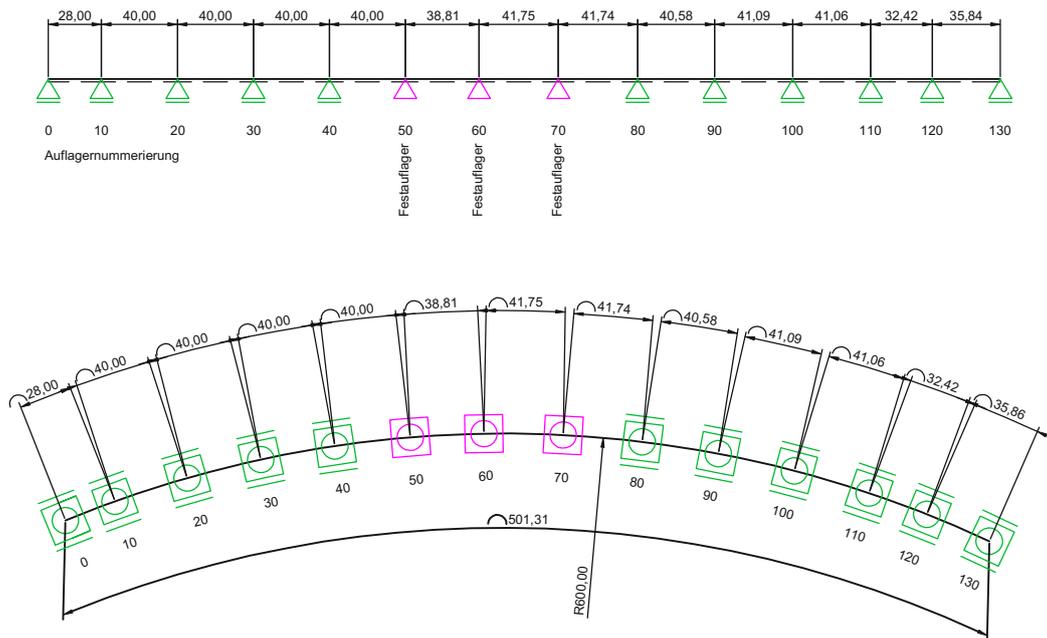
Statisches System Neubau und Bestand Objekt 2314 (Eigene Darstellung in Anlehnung an den ASFINAG Bestandspläne Objekt B2314)
